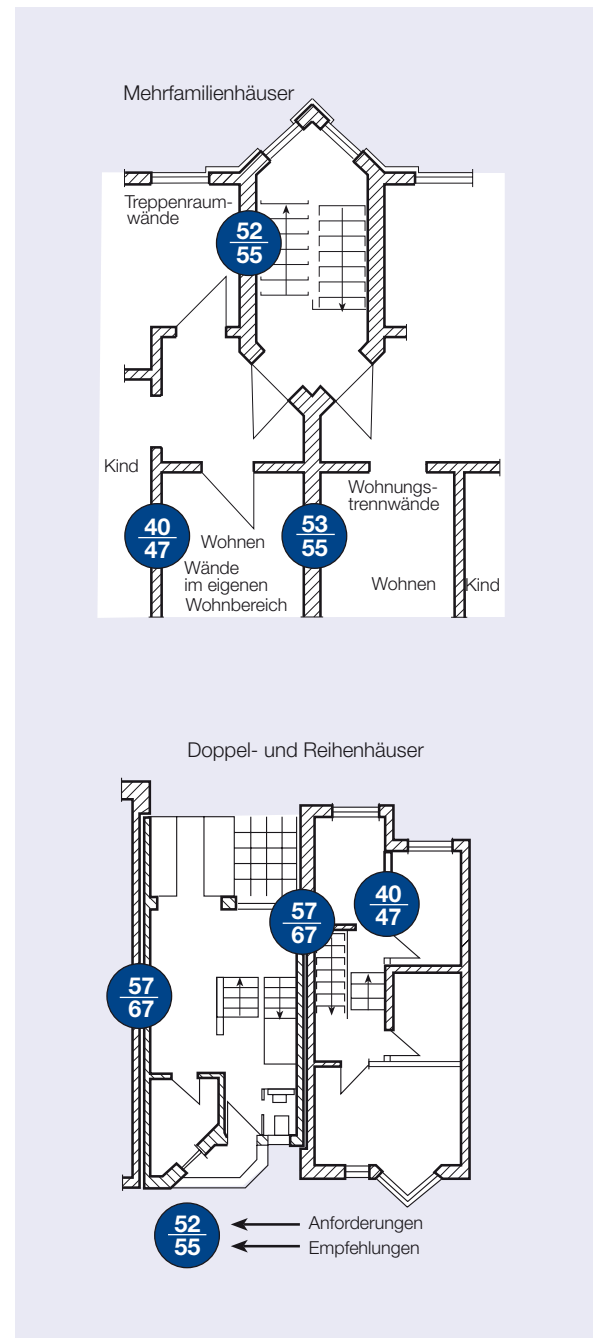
Anforderungen nach DIN 4109 und Vorschläge für den erhöhten Schallschutz nach Beiblatt 2 der DIN 4109 an ausgewählten Grundrissen.
